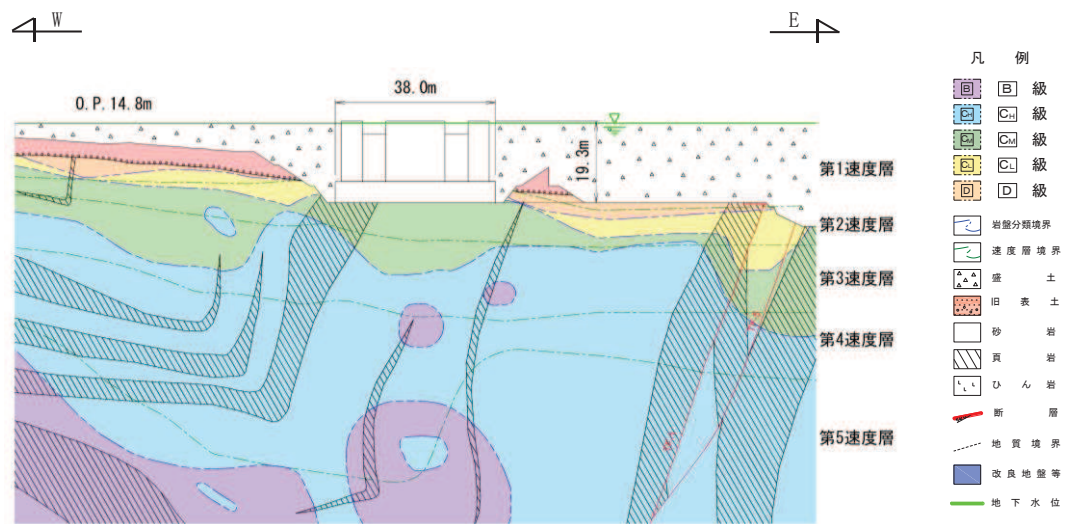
排氣筒基礎 地震時荷重算出用地質断面图 (EW 断面)
